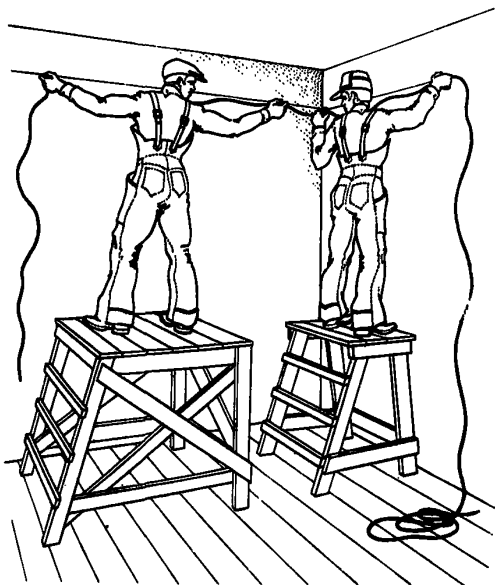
Разметка и отбивка на стенах и потолке линий трассы электропроводки
